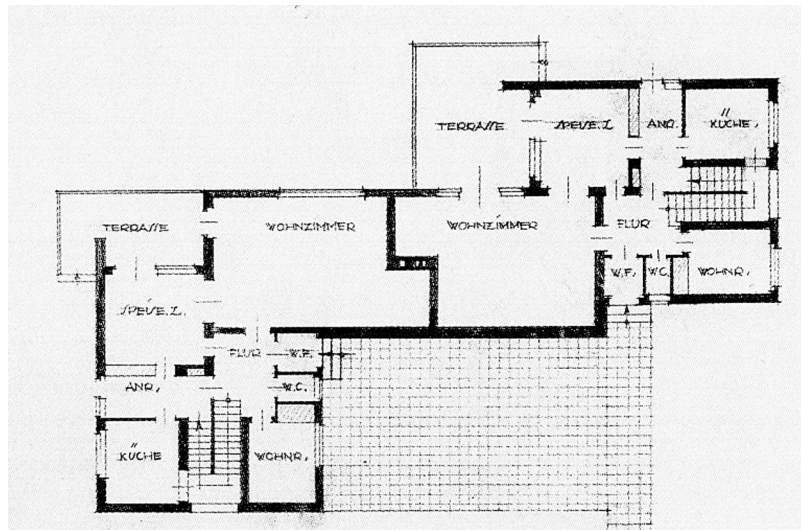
W. Gropius, *Grundrisse Häuser d. Bauhausmeister*, Dessau 1926
